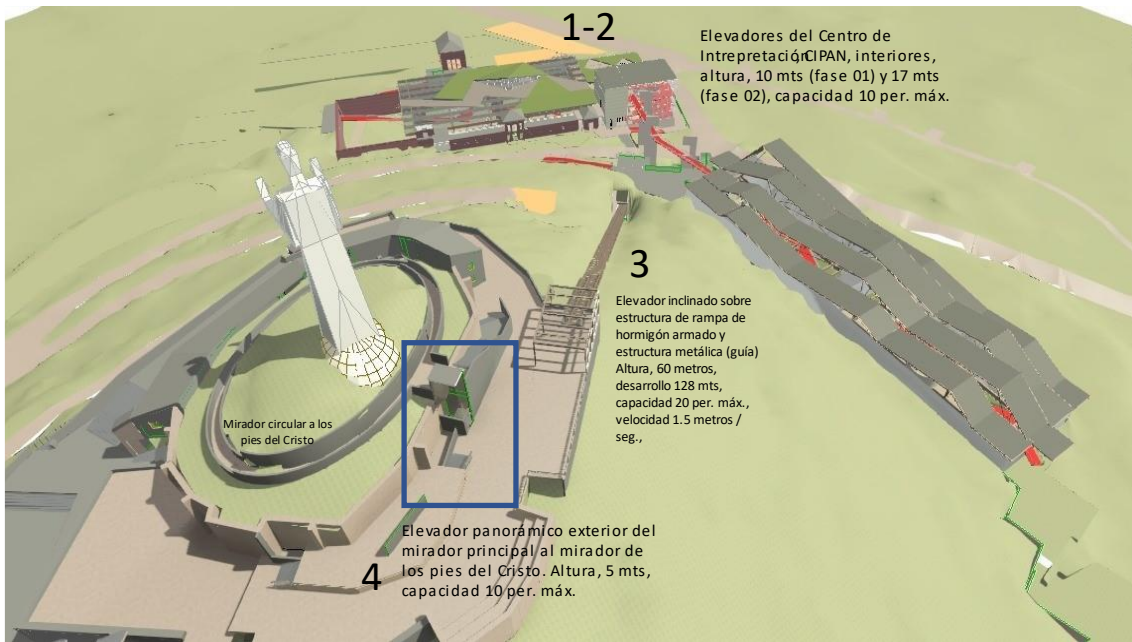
Vista general de la propuesta del Plan Director con el mirador de los pies del Cristo en primer plano.
